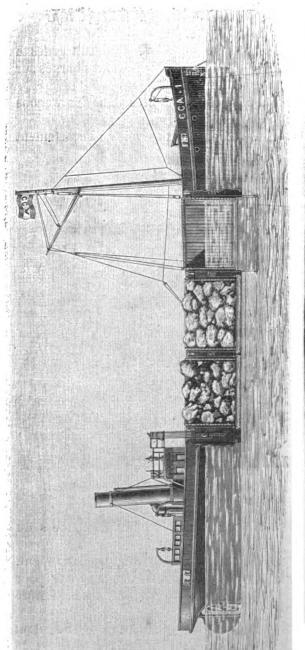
Plan et coupe longitudinale du bateau à clapets pour le transport des enrochements.
